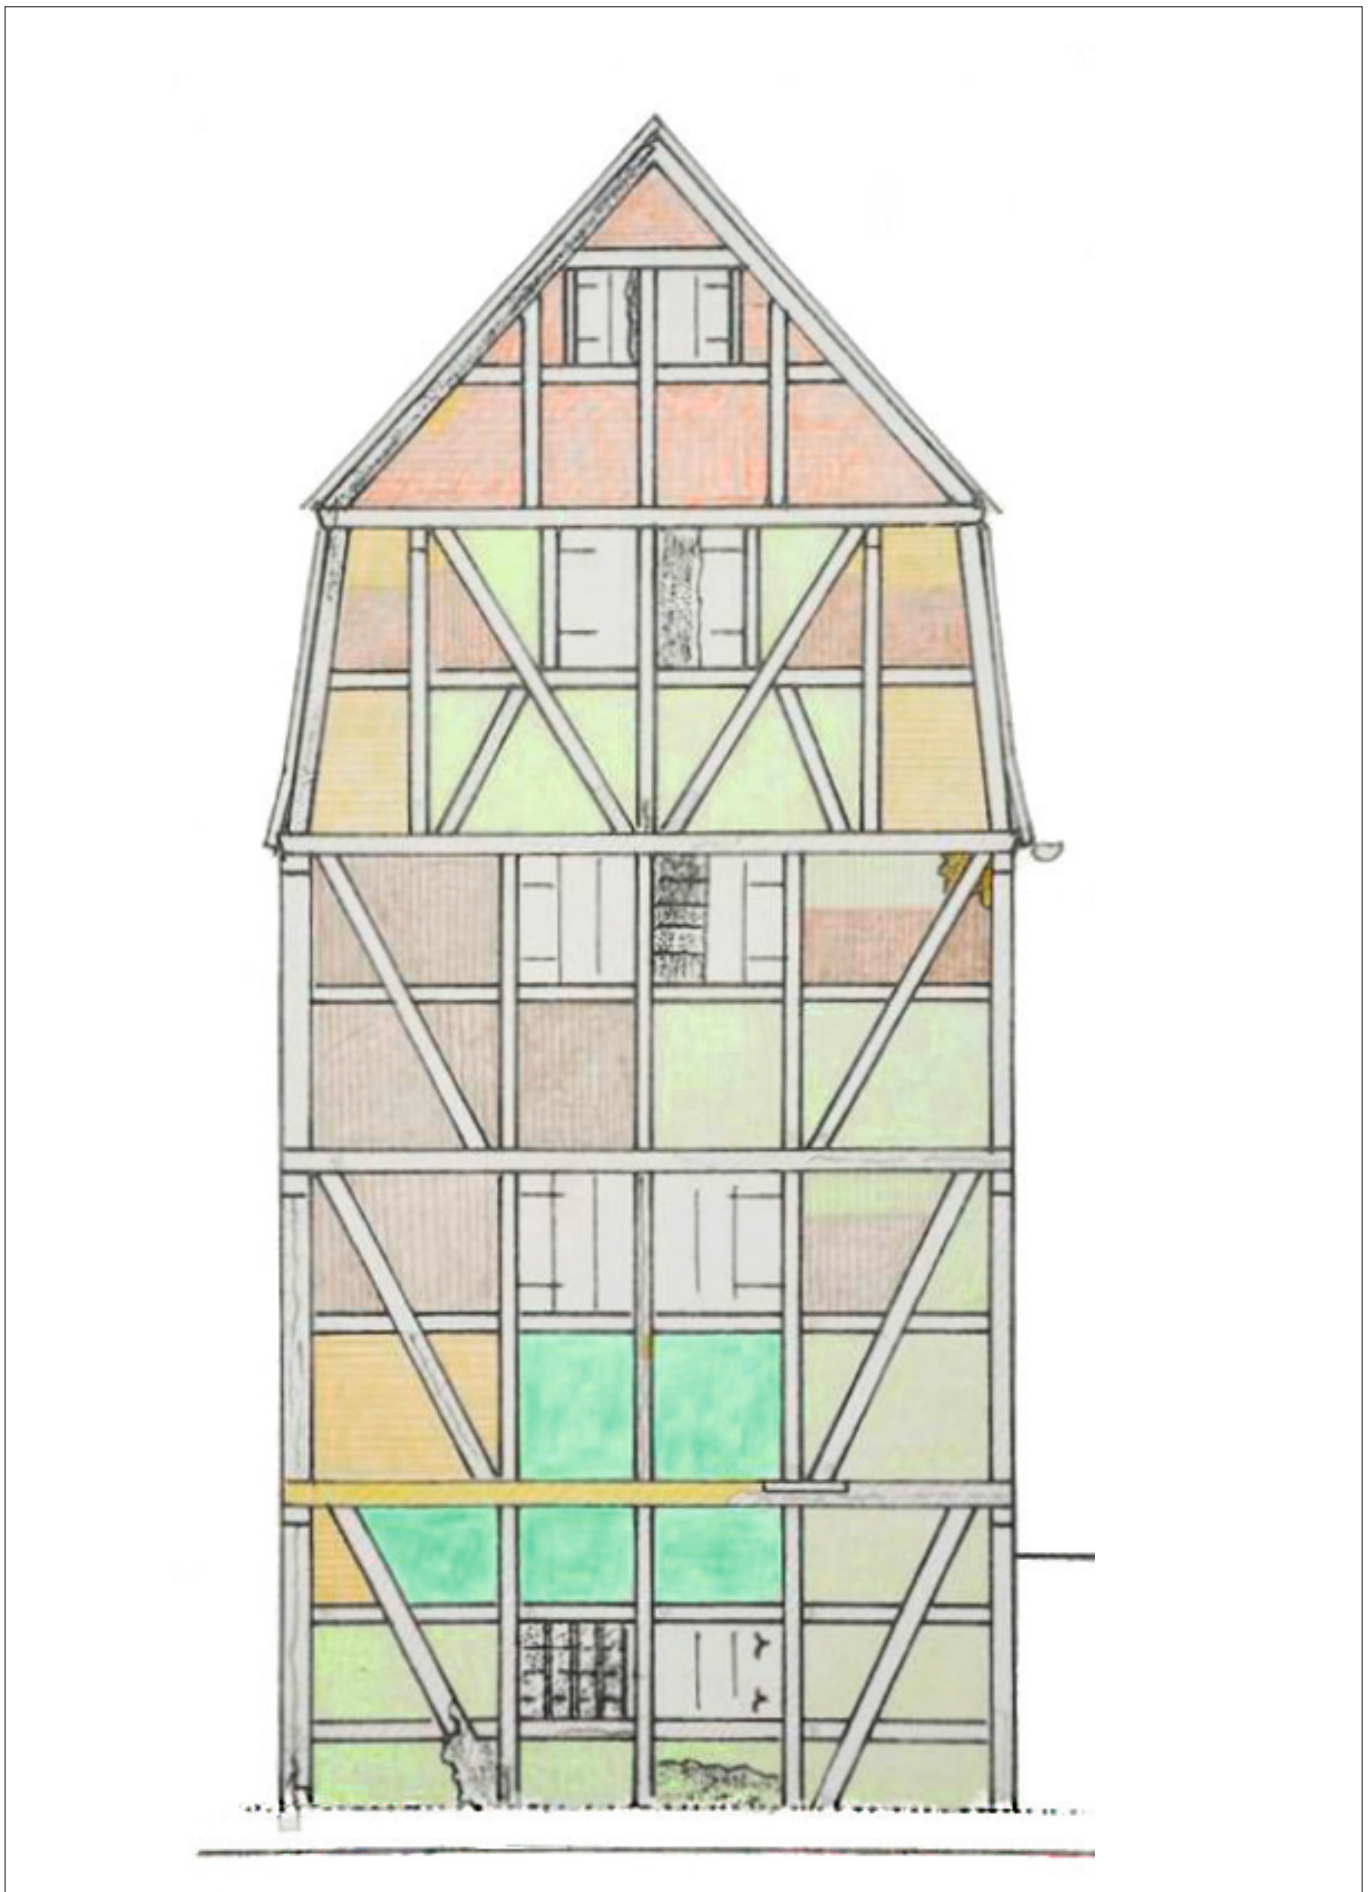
Ansicht Nordfassade, Ausfachungen mit Baualterskartierung
